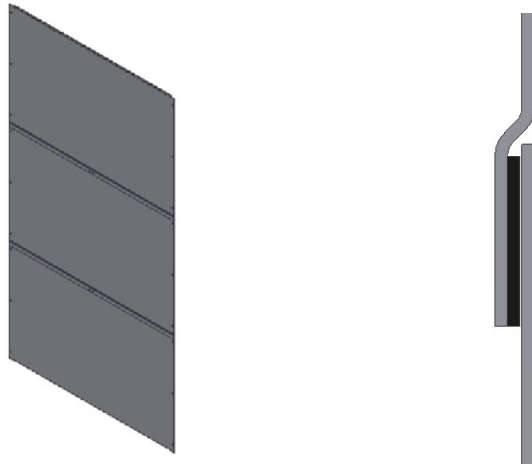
Detalle de pestaña tipo bayoneta y el empalme con la siguiente cubierta.
